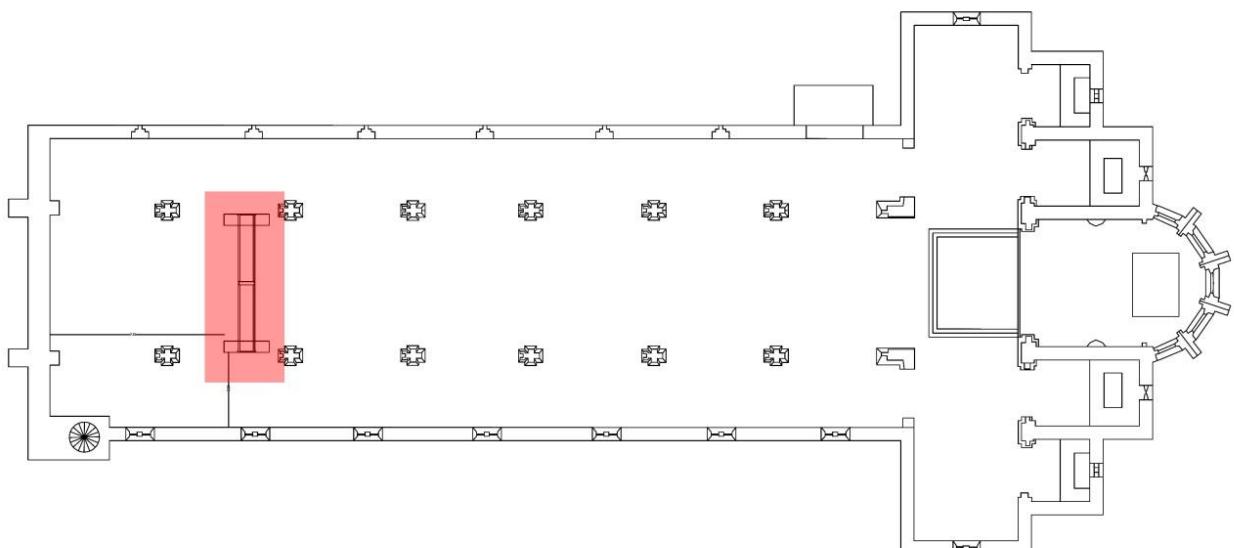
Planta da igreja – Desenho de Jorge de Sá.
